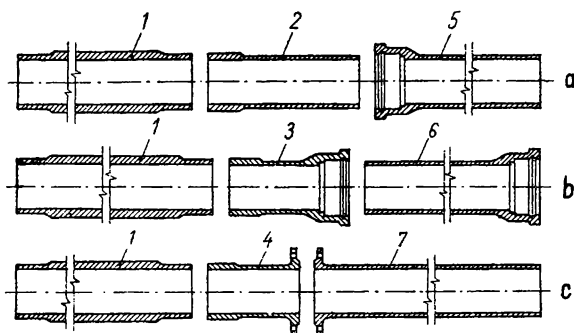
Îmbinarea tuburilor de azbociment cu tuburile de fontă de presiune :
